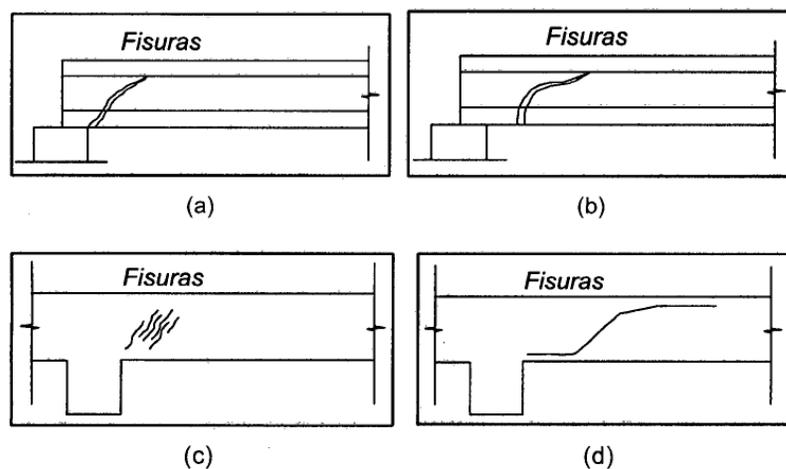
Tipología de las fisuras en vigas debido a esfuerzos de corte
